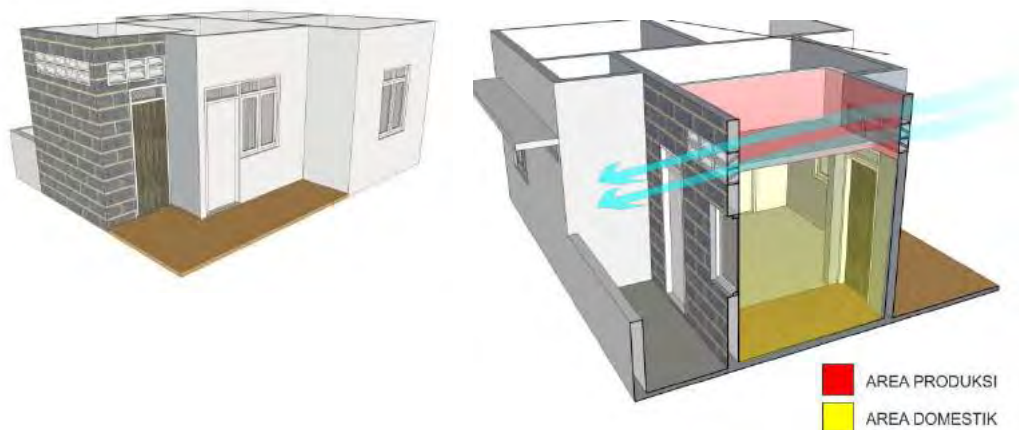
Denah dan tampak tipe simplex terpilih
